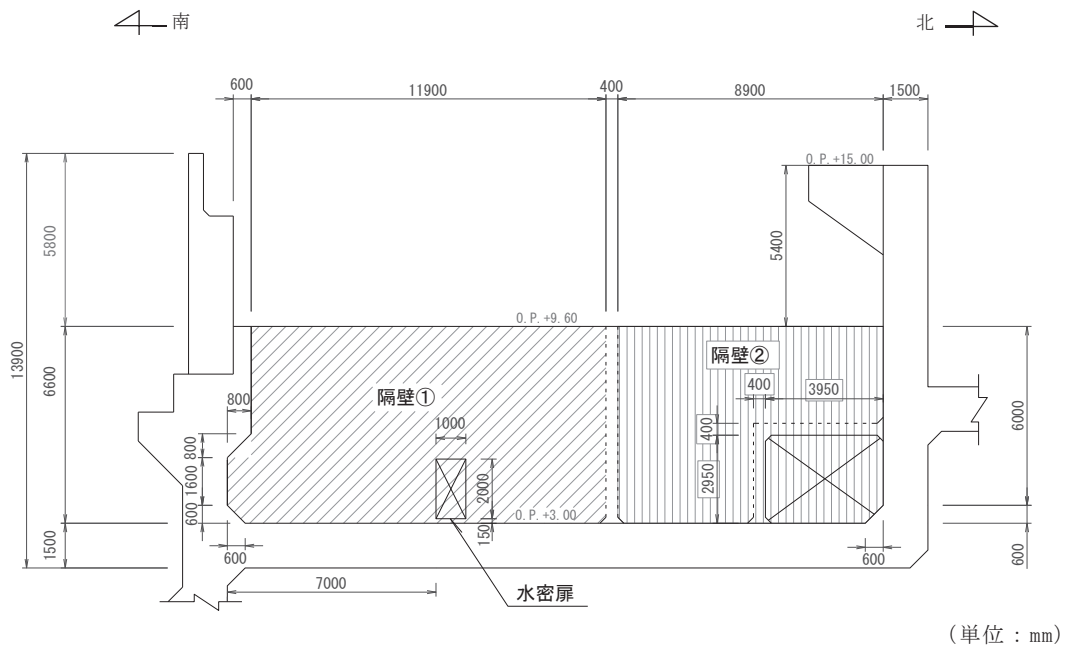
(2) 補機ポンプエリア断面図 (②—②断面)
